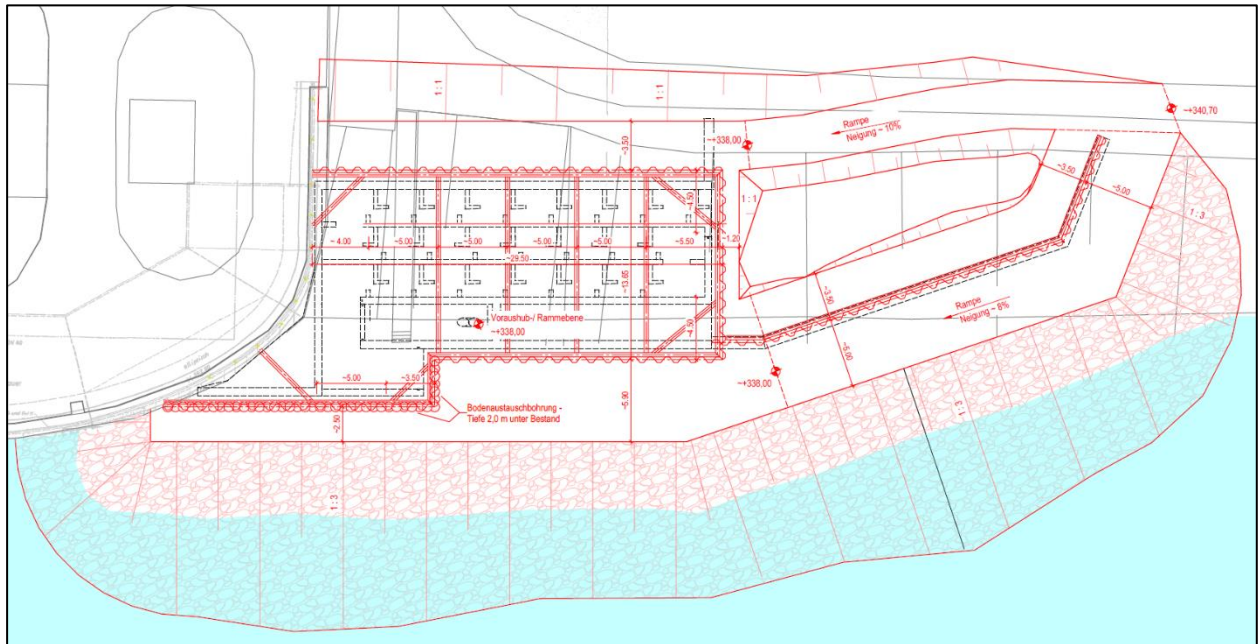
Baugruben-Lageplan Einstiegsbauwerk
